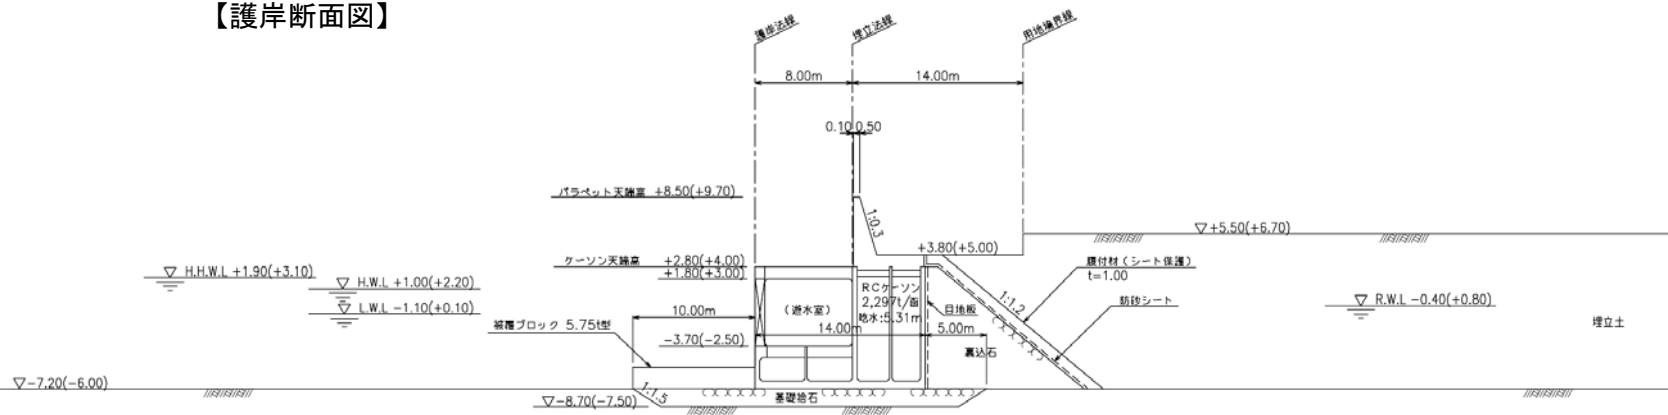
(2) 代替施設本体のケーソン式護岸断面図及びケーソン正面図 (中水深区間)
